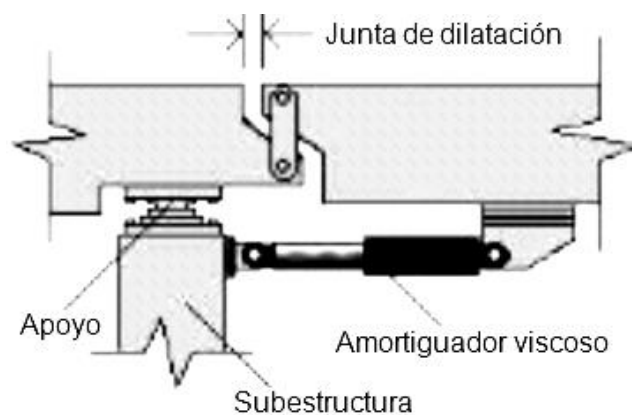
Elementos complementarios de la superestructura de un puente [13]
